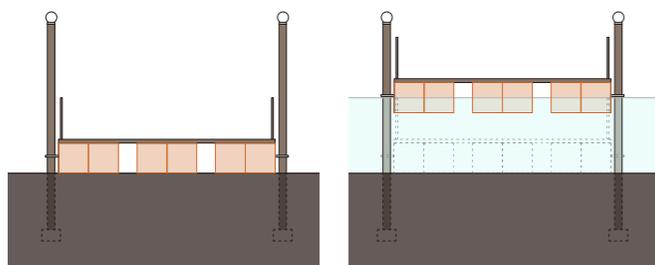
Schema funzionamento galleggiamento passerelle
